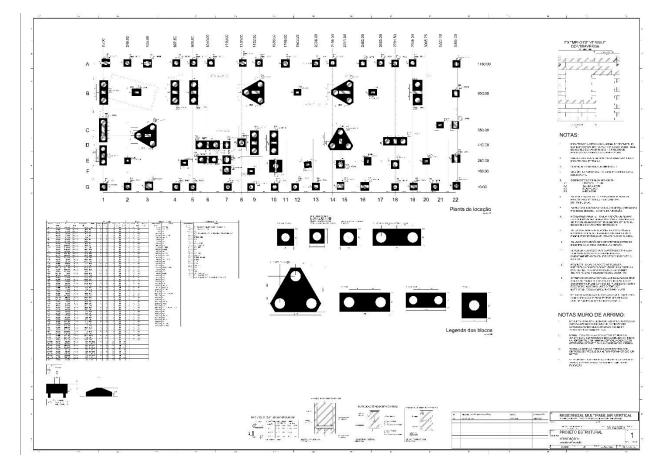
Projeto Estrutural Com A Adoção Da Norma ISO 9001:2015
